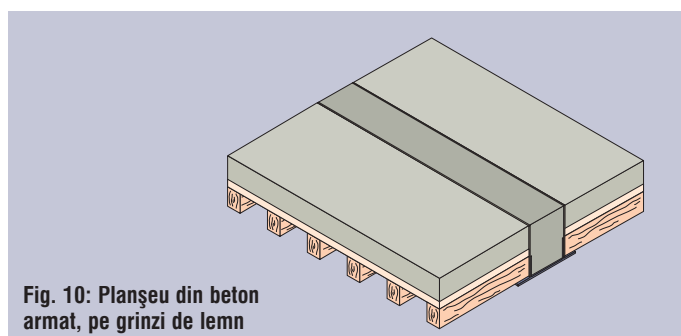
Planșeu din beton armat, pe grinzi de lemn
